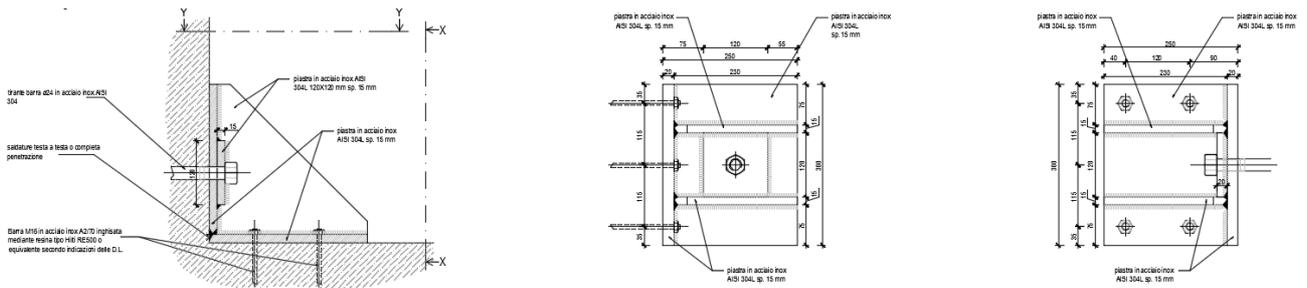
Sezione e prospetti dell'ancoraggio d'angolo
